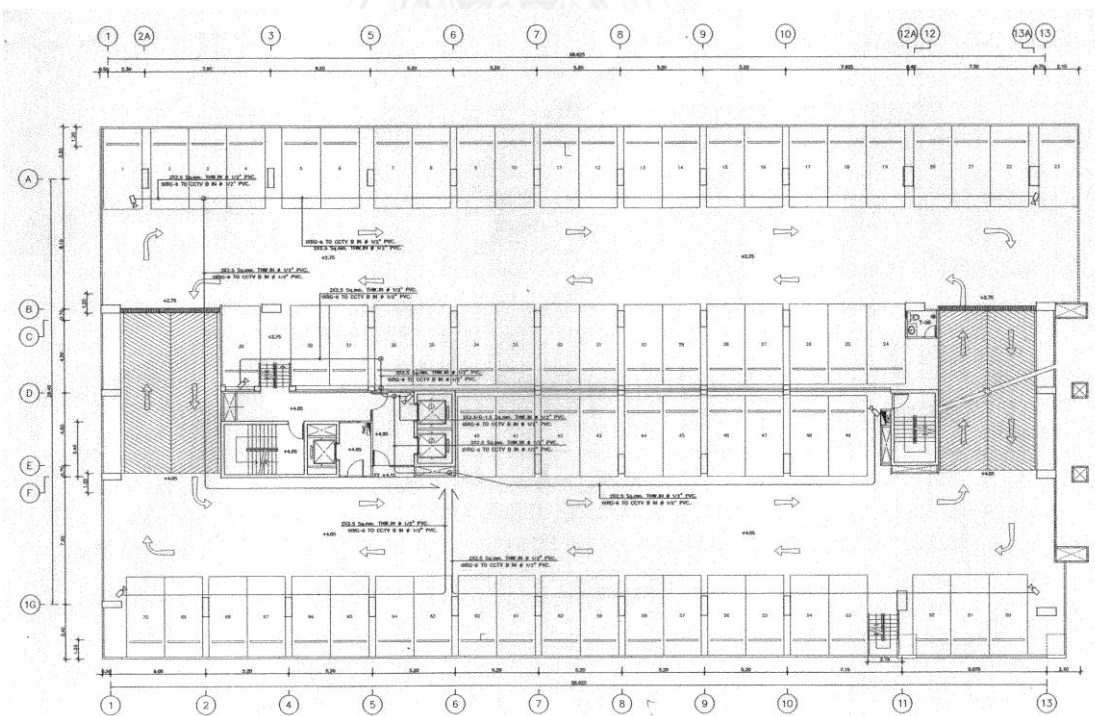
3 แสดงผังพื้นชั้น G-3 อาคาร A ของโครงการลุมพินี วิลล์ พหล-สุทธิสาร
